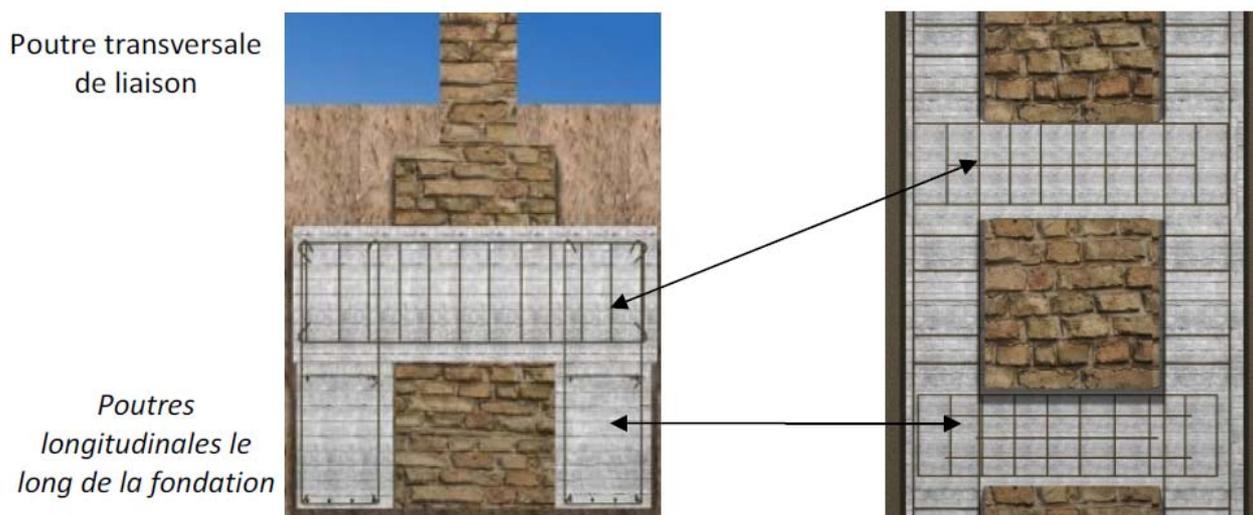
renforcement des fondations par des poutres longitudinales rattachées par des poutres transversales
